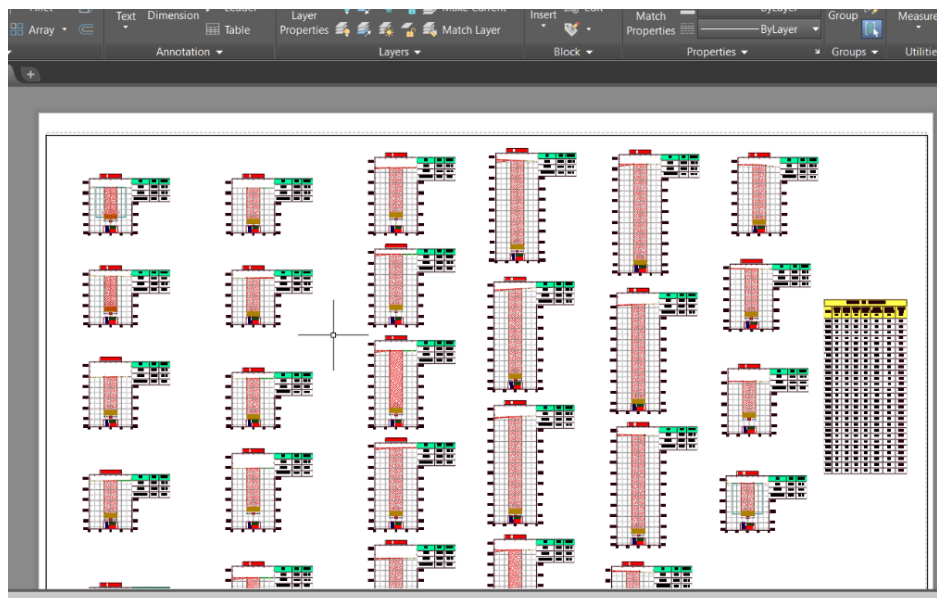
Se obtiene el seccionamiento de la red de alcantarillado.
